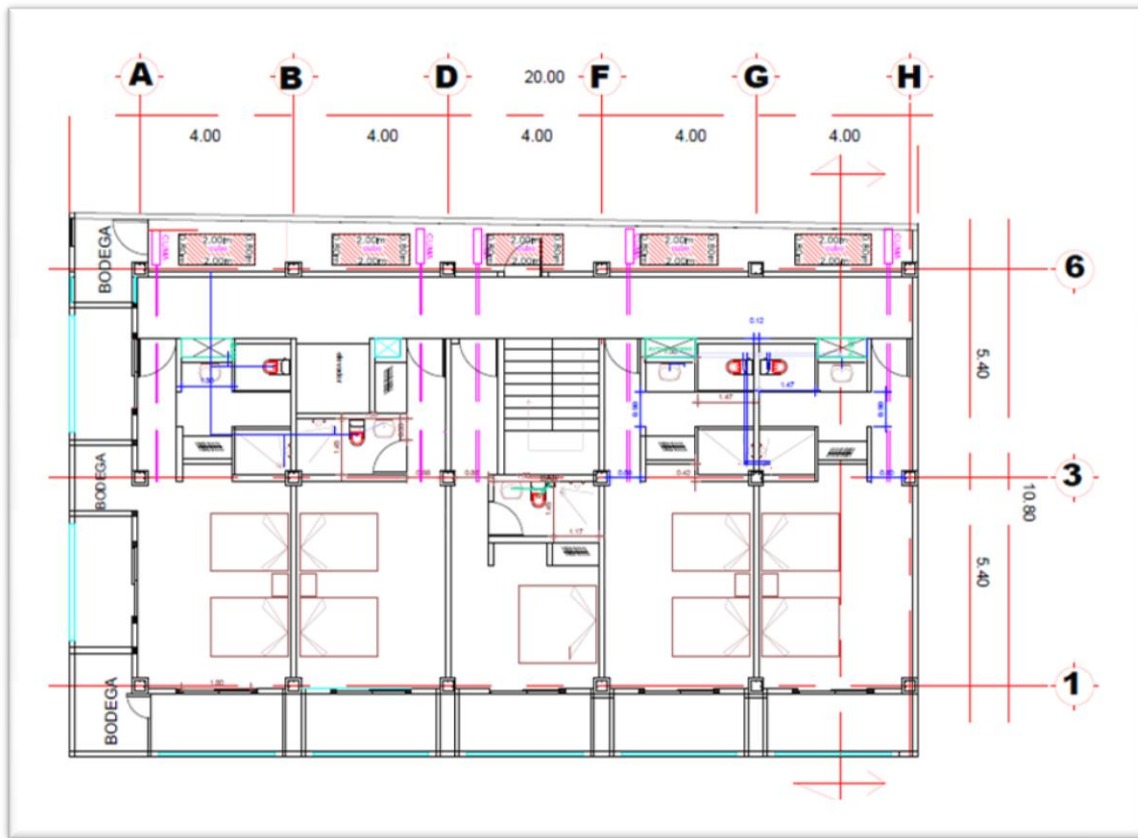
Planta tipo 2o hasta 50 nivel (piso)
